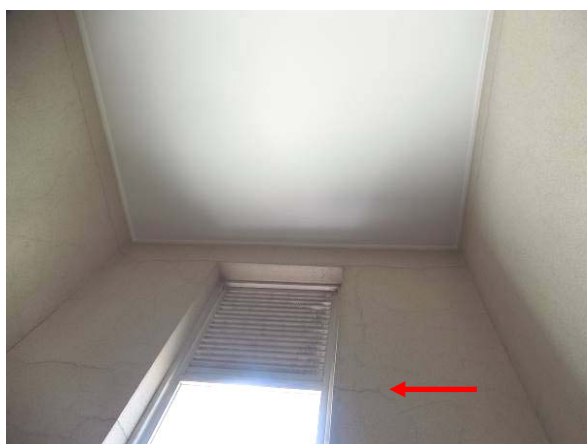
Idem. Idem. Idem. Idem. Fissuração mapeada e fissuras dispersas e aleatórias, aparentemente, com atravessamento da parede de fachada (ver figura 21).
